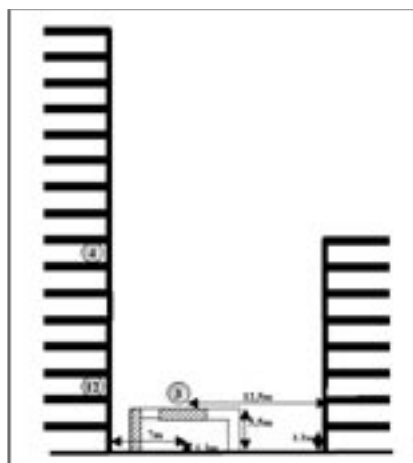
Proyección en alzado de la instalación con los puntos de cálculo señalizados.
